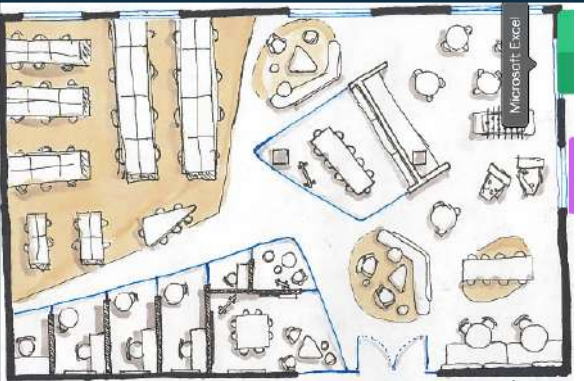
Oficina AEC Networks planta arquitectónica. Fuente: AEC Networks.
